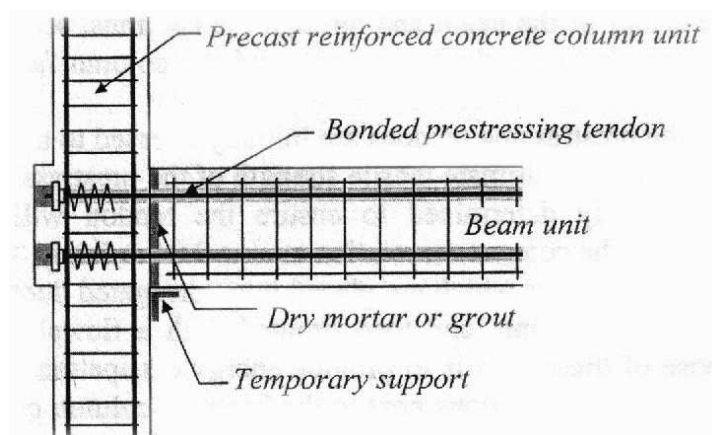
Sistema di collegamento mediante funi post-tesate trave-pilastro – Soluzione progettuale n.12
